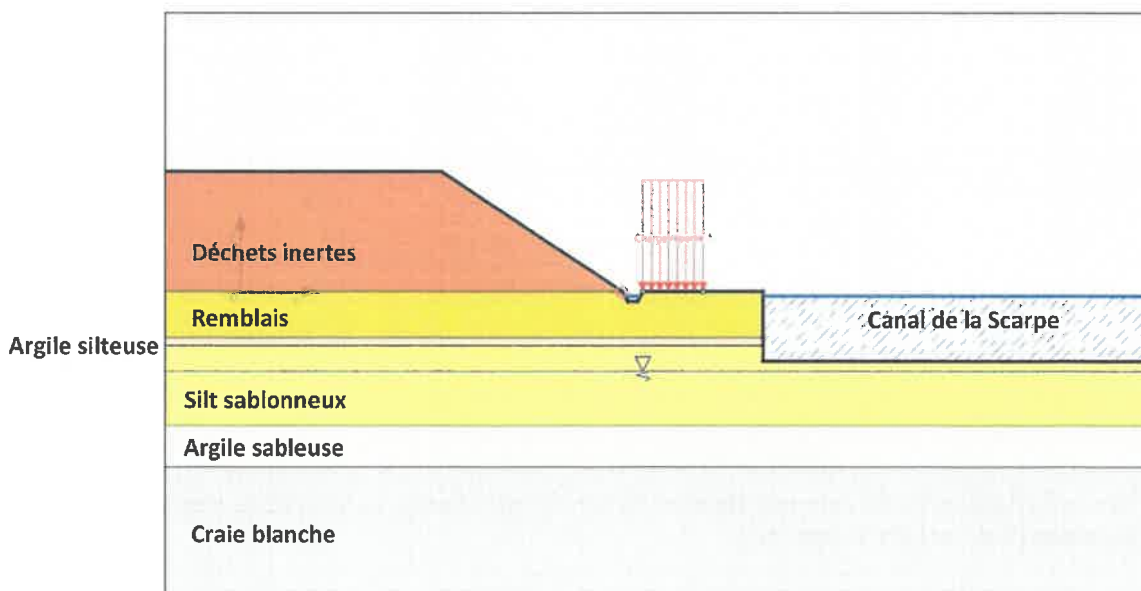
Vue en coupe du projet – Profil B – vers le canal de la Scarpe – Modélisation TALREN
